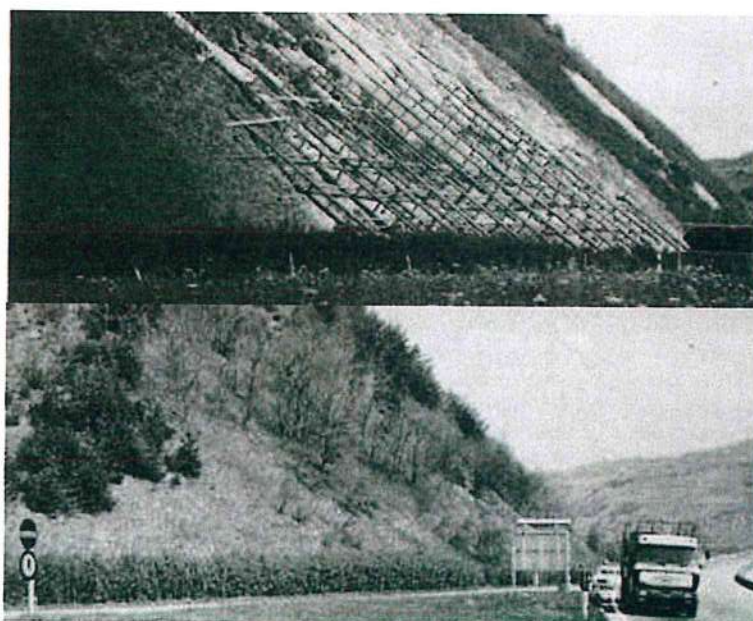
Emparrillados vivos de ladera para la estabilización de un talud muy inclinado. Arriba, durante la construcción. Abajo, después de ocho años.
